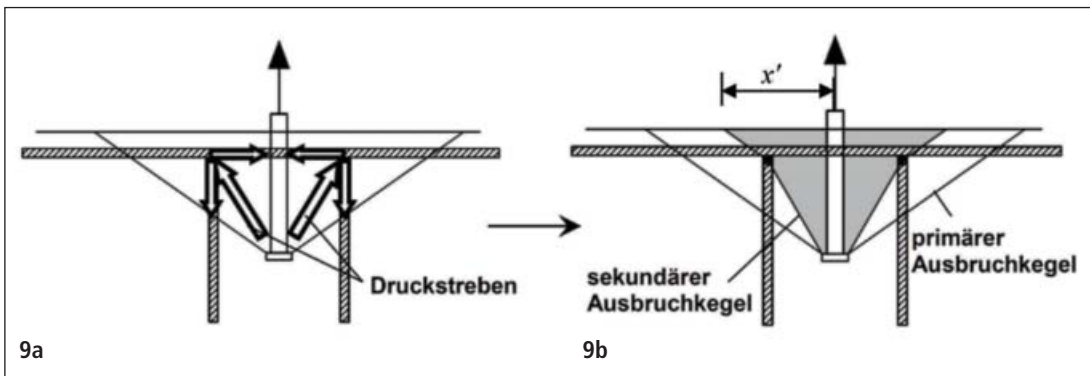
Zugbeanspruchter Kopfbolzen mit Rückhängebewehrung, nach Berger [10]; a: Kräfteinleitung in die Bügel, b: Bruchkörper bei Druckstrebenbruch
